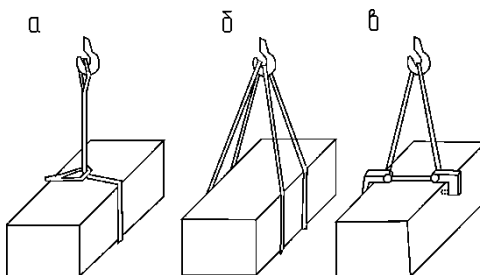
Схема строповки блоків канатними вантажозахватними пристроями [2]
